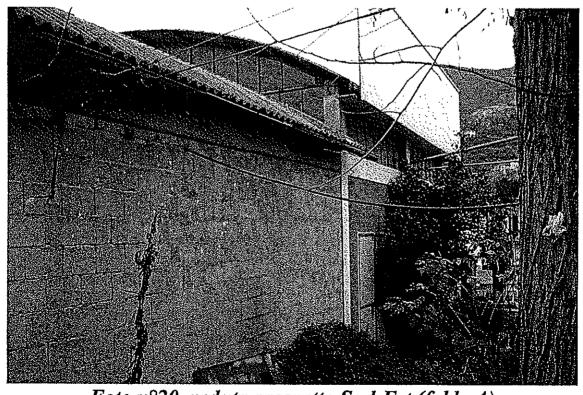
, veduta prospetto Sud-Est (fabb. A)
